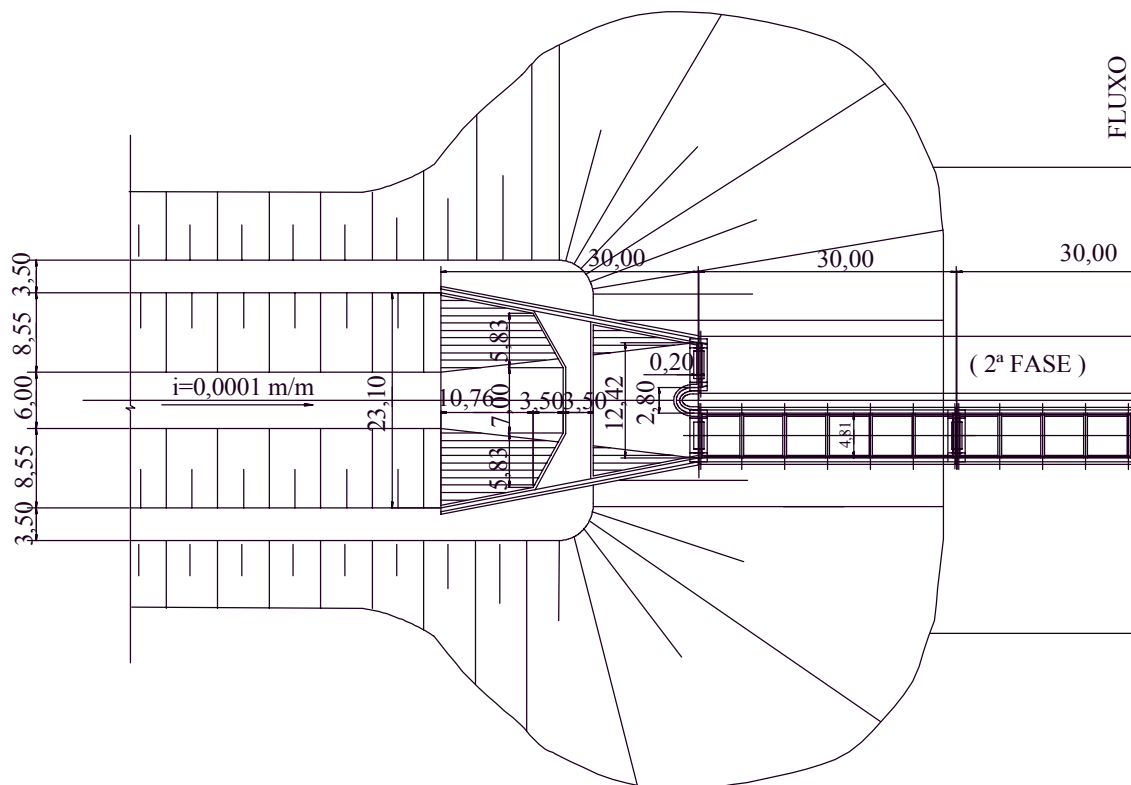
Planta do Emboque e Desemboque do Aqueduto
